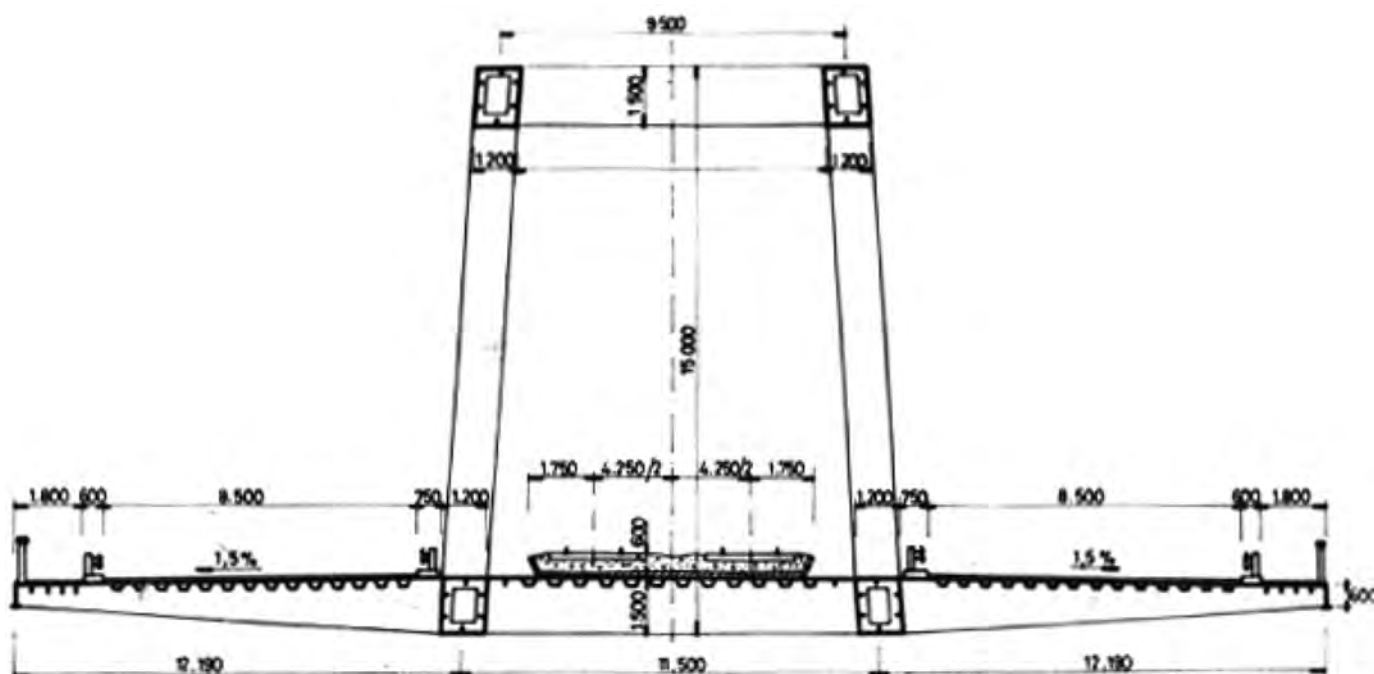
Pod peste Dunăre la km 173, Șantier Naval Brăila. Secțiune transversală supradenivelare
